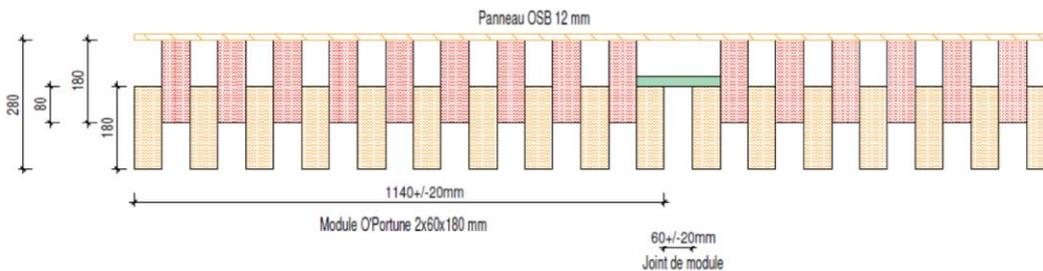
Dalle O'portune®, en planches vissées décalées, pour des portées de 6 m à 11 m
